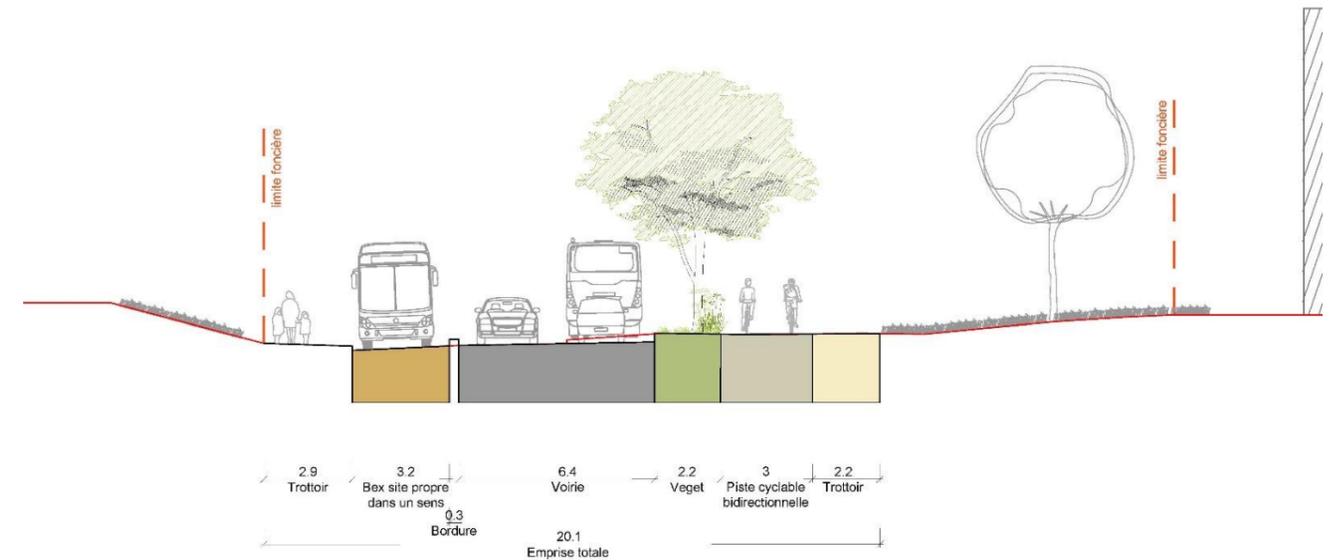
Coupe type sur l'avenue Pierre Proudhon
